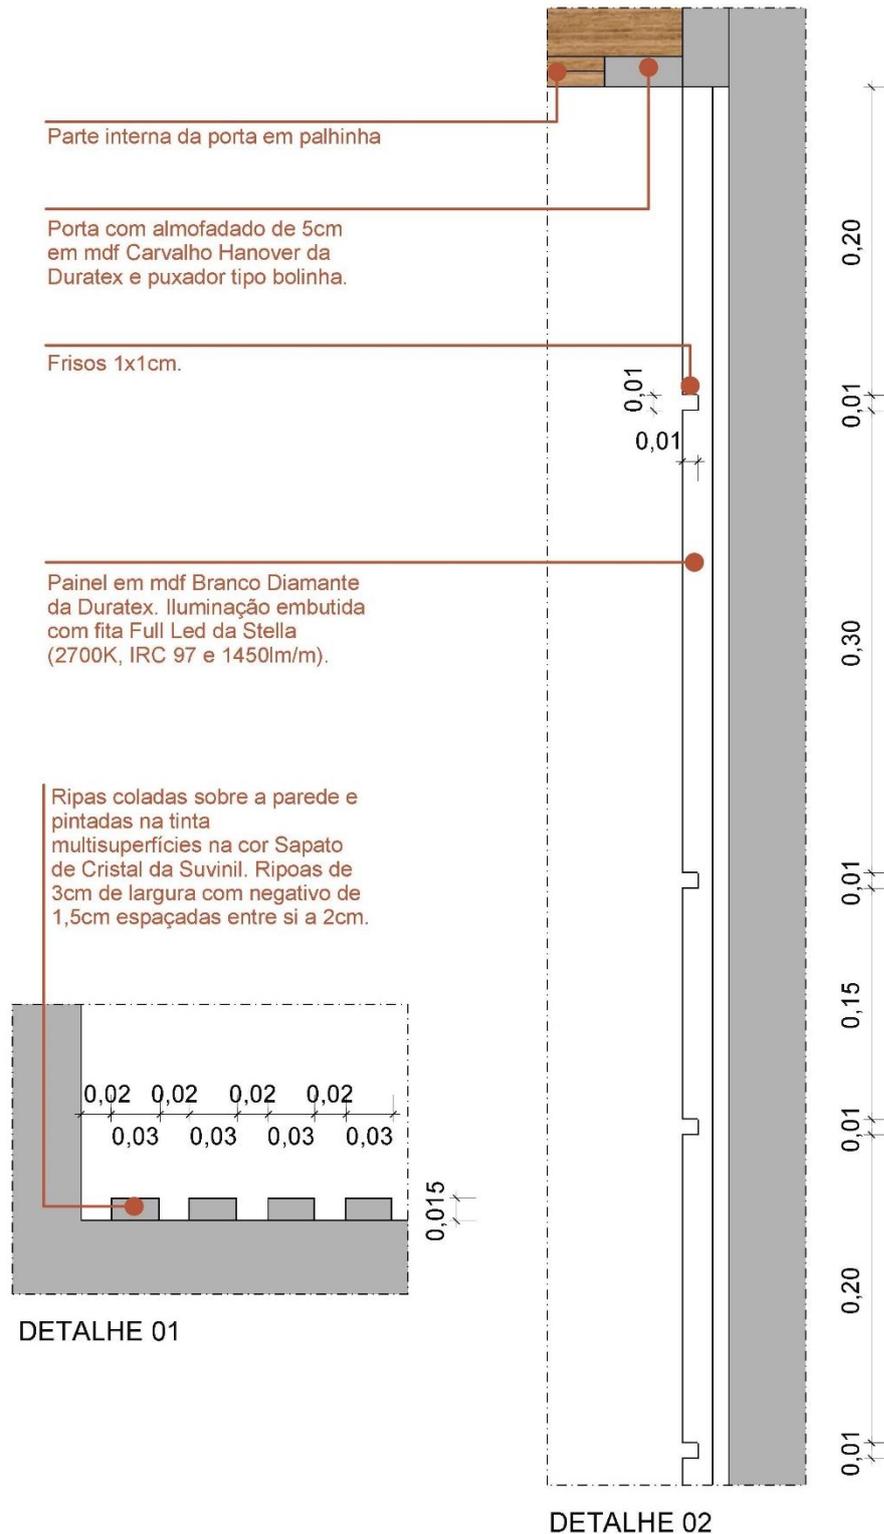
Planta Baixa Marcenaria, escala 1/25.
